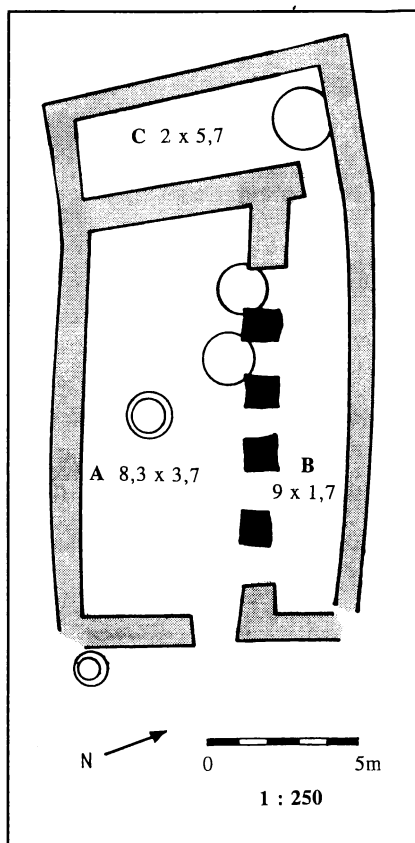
Ḥirbet Raddāne*: Grundrißskizze des Haustyps mit Querraum und mit Pfeilerreihe
